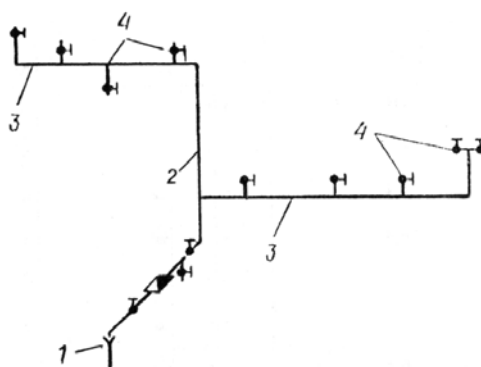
Схема водопроводной сети с вертикальной разводкой магистрали и с горизонтальными распределительными трубопроводами:
